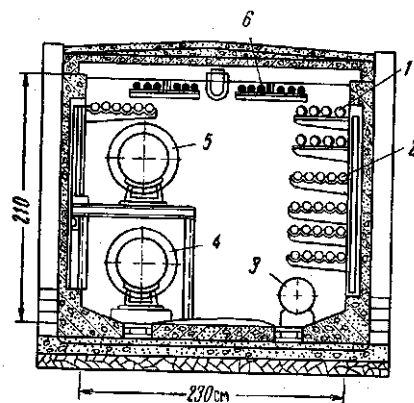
Поперечное сечение общего туннеля для подземных сетей: 1 — кабели силовые; 2 — кабели связи; 3 — водопровод; 4 — подающий теплопровод; 5 — обратный теплопровод; 6 — кабели внутреннего обслуживания
